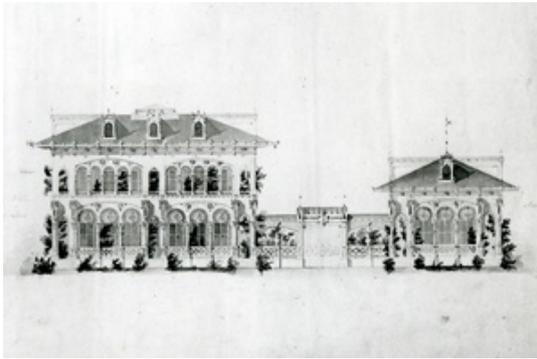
Skizze 13c, Fassadenriss
